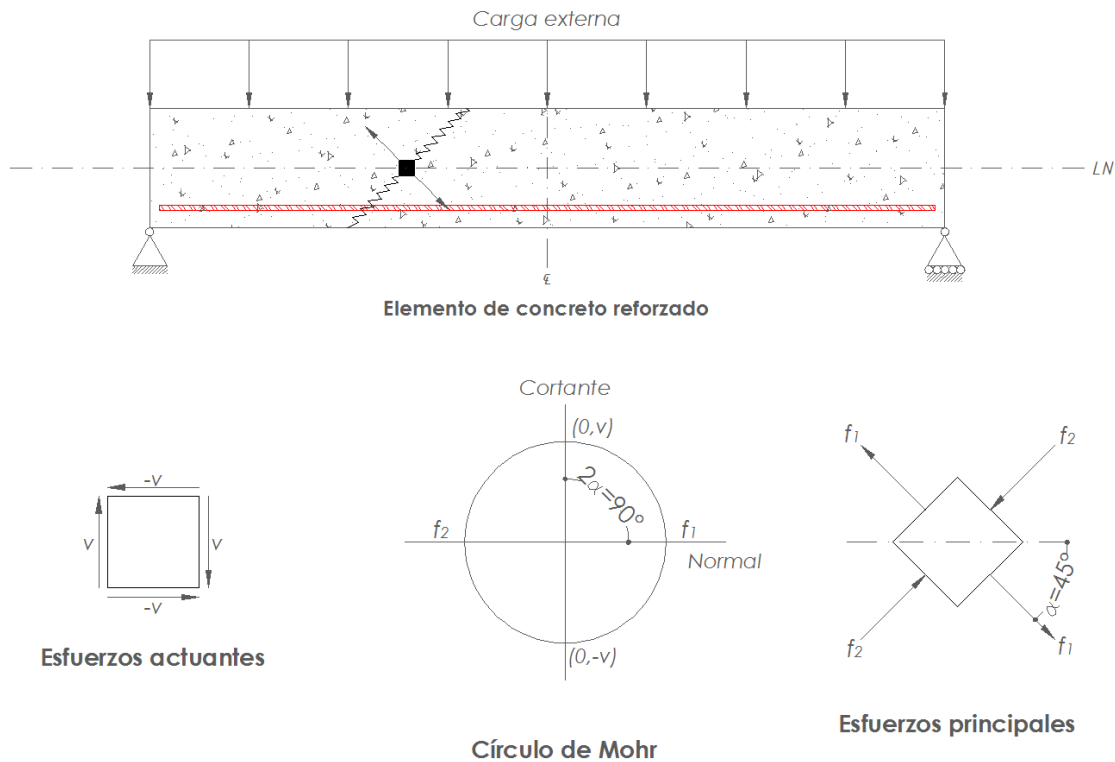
Estado de esfuerzos en un elemento de hormigón reforzado
